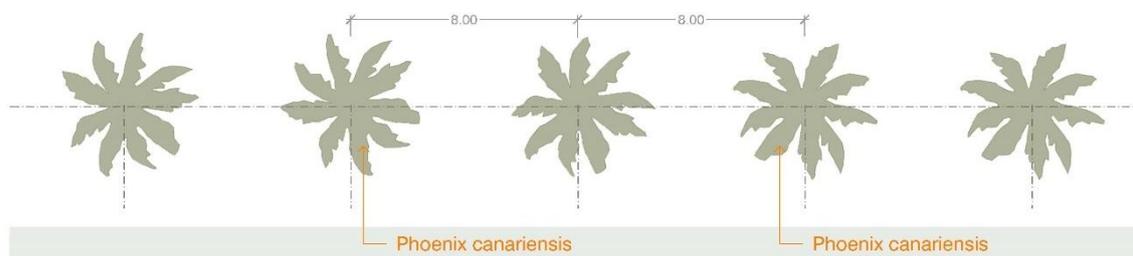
Sesto d'impianto Palme banchina Terrapieno Ovest
